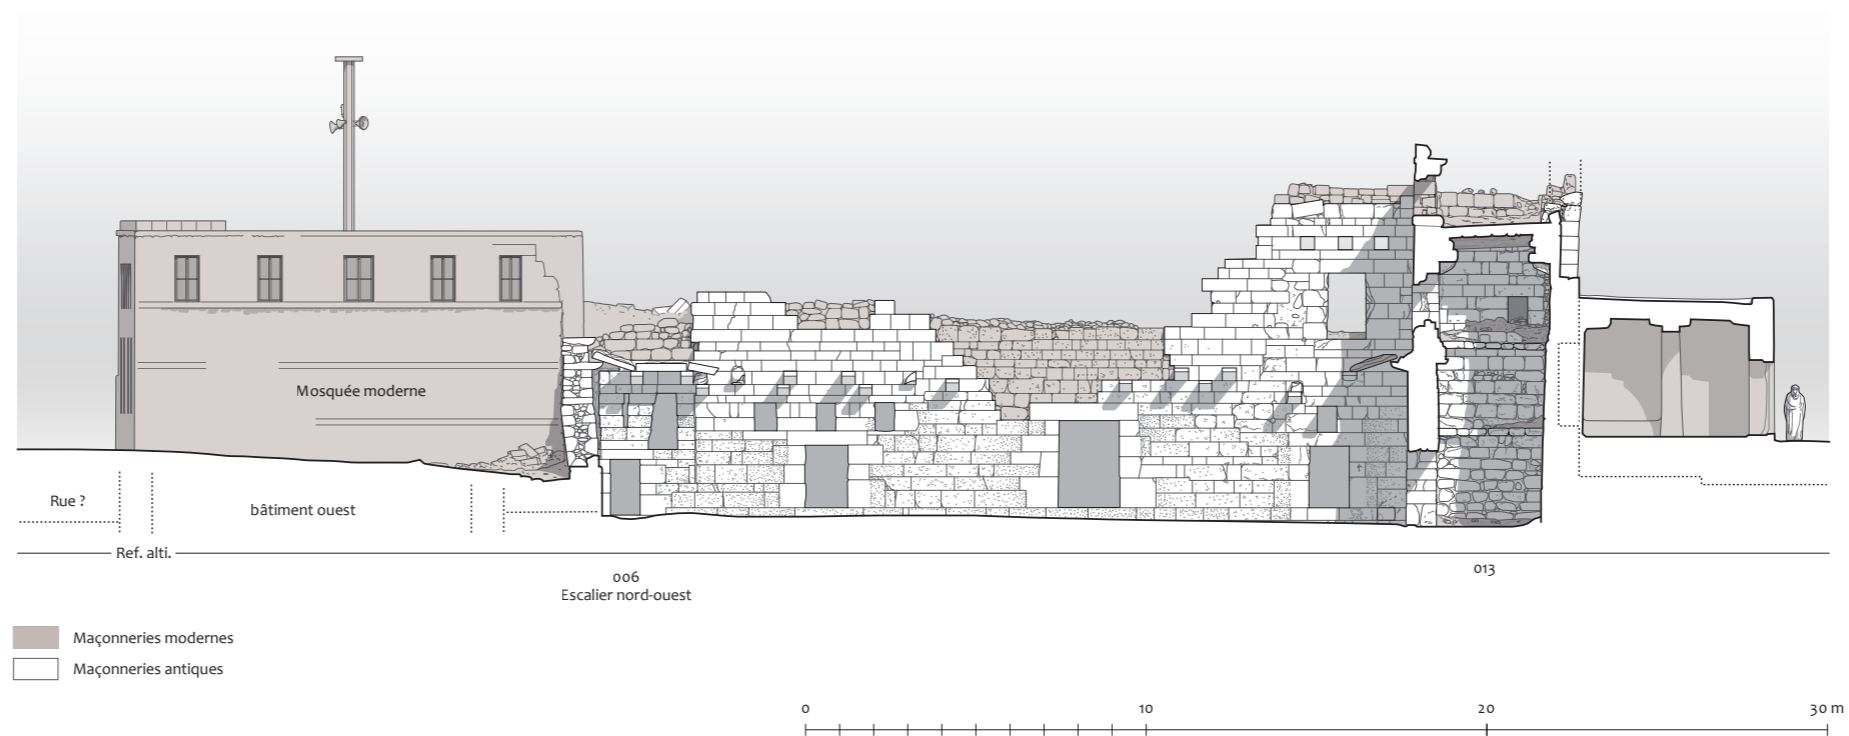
Le « Palais de Trajan », coupe 2, façade nord sur cour. Bâtiment nord (état des lieux 2009, 1/200^e)
